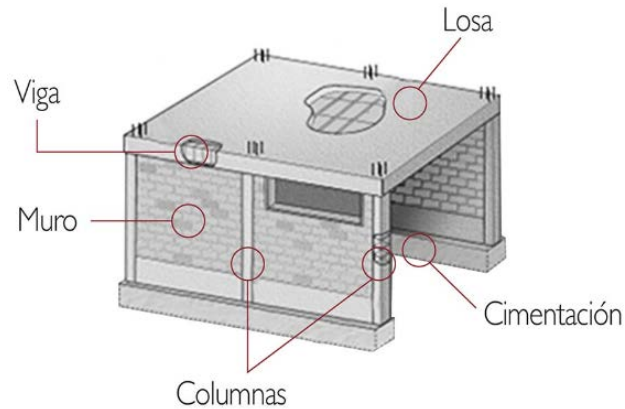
Elementos estructurales de vivienda de Albañilería Confinada.
